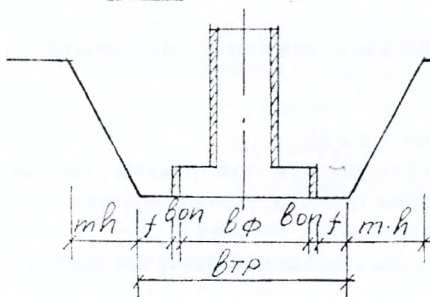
Схема траншеи под ленточный монолитный фундамент (опалубка показана условно)
